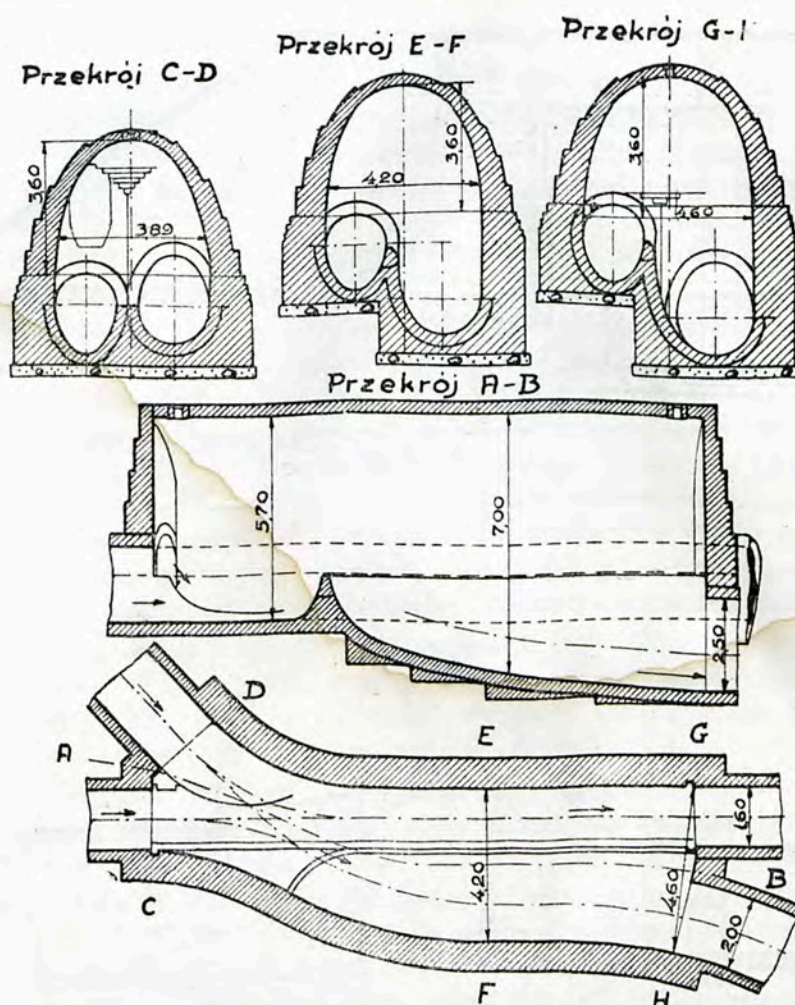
Przelew burzowy przed oczyszczalnią ścieków w Otwocku.
